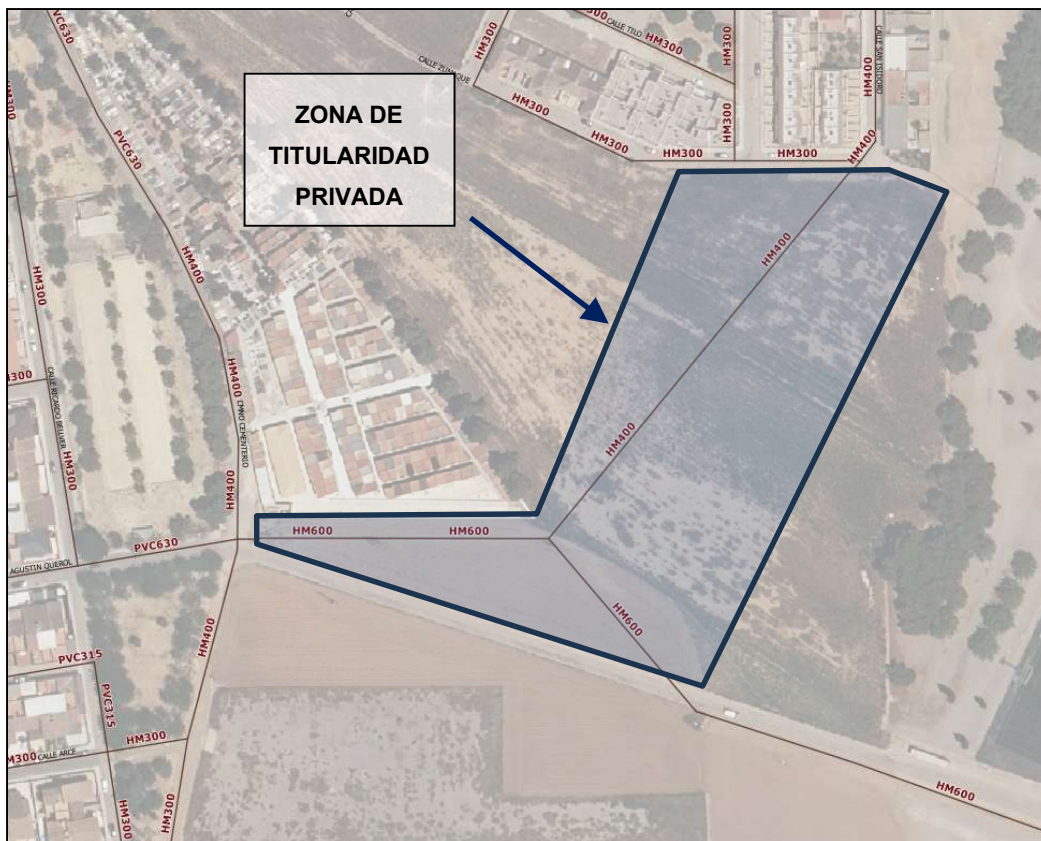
Red de alcantarillado existente en el Camino del Cementerio y la C/Rondo.
